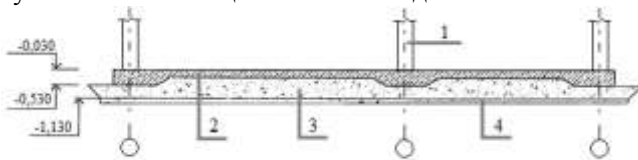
Железобетонная фундаментная плита: 1 – колонна, 2 – фундаментная плита (В25), 3 – песчаная подушка, 4 – утрамбованный щебень (200 мм)
